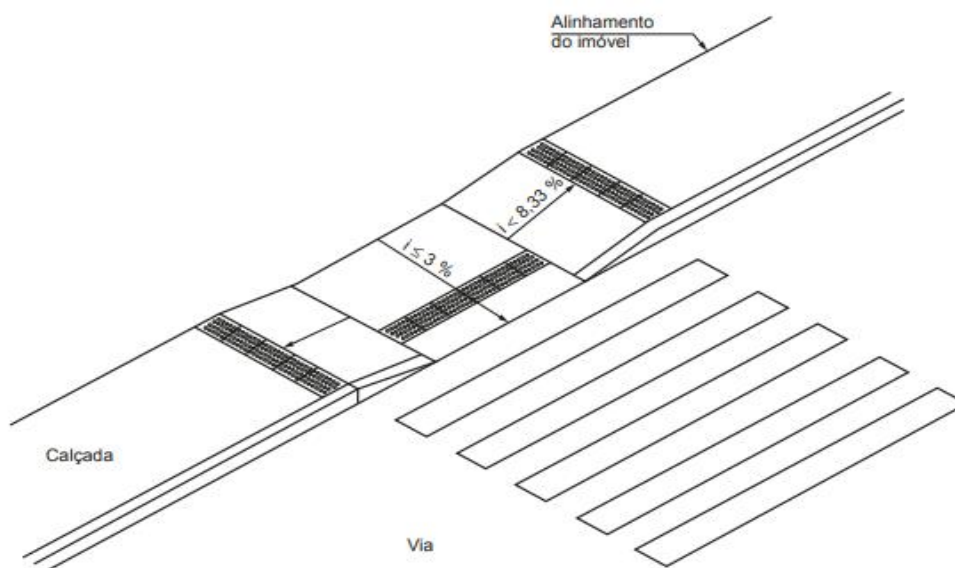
Vista superior rebaixamento de calçadas estreitas
